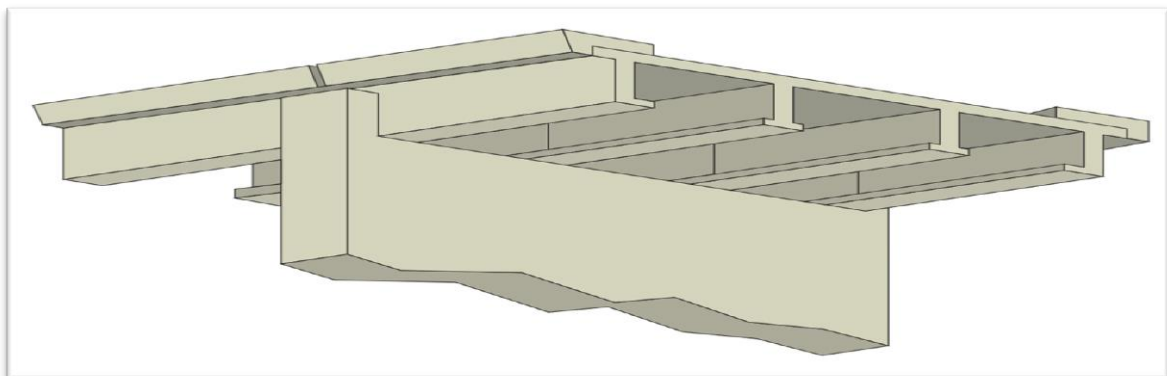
Morphologie générale d'un pont à poutres en béton précontraint.
